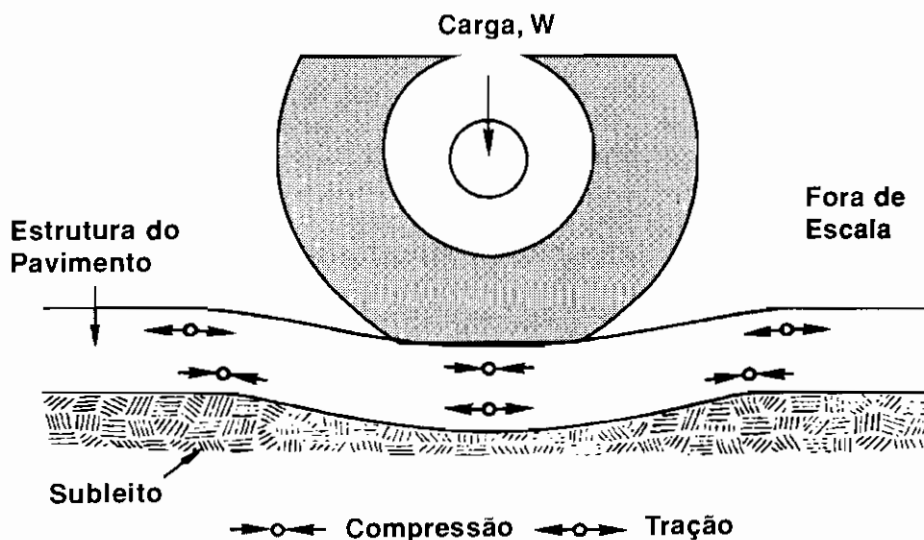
Deflexões no pavimento resultam em tensões de tração e compressão na estrutura do pavimento.
